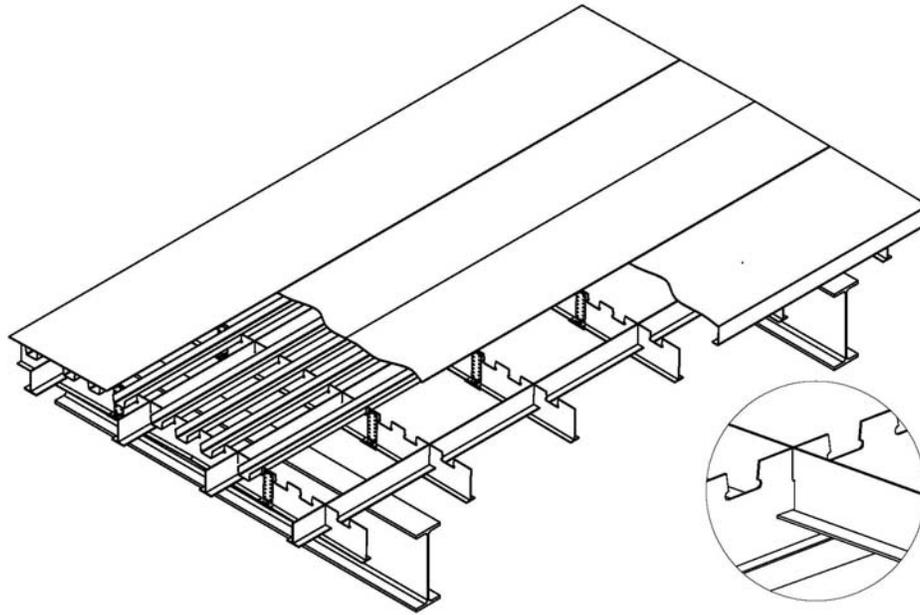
Panneau de tablier avec poutres principales et extension en porte-à-faux
